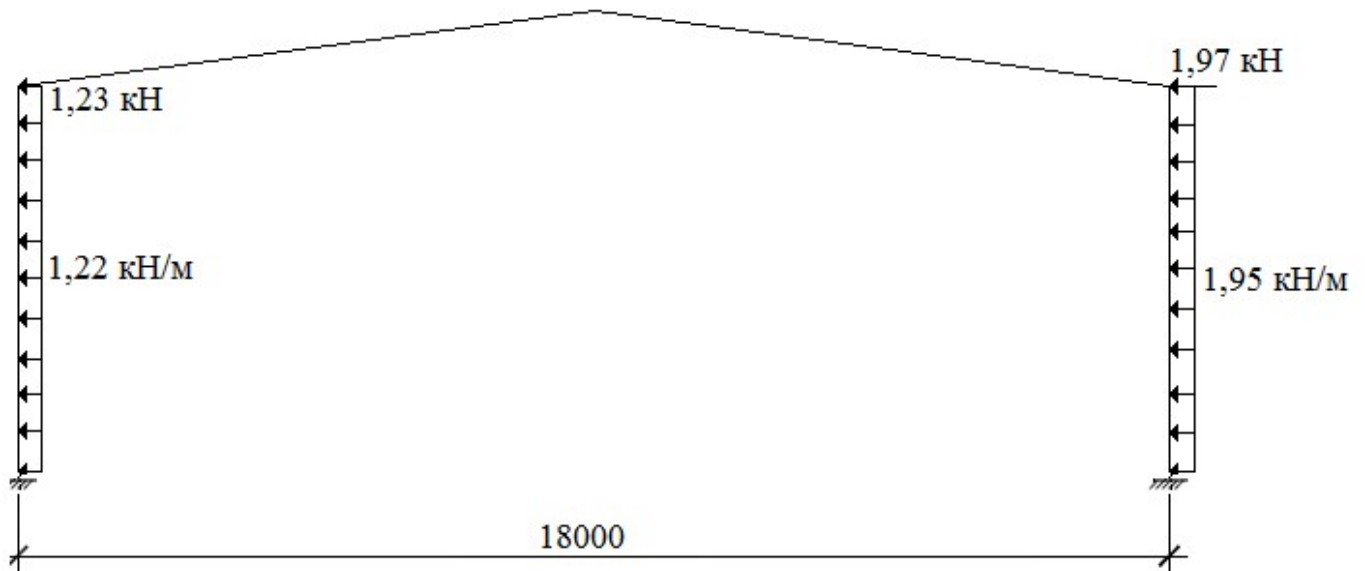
Схема загрузки от ветровой нагрузки справа здания
